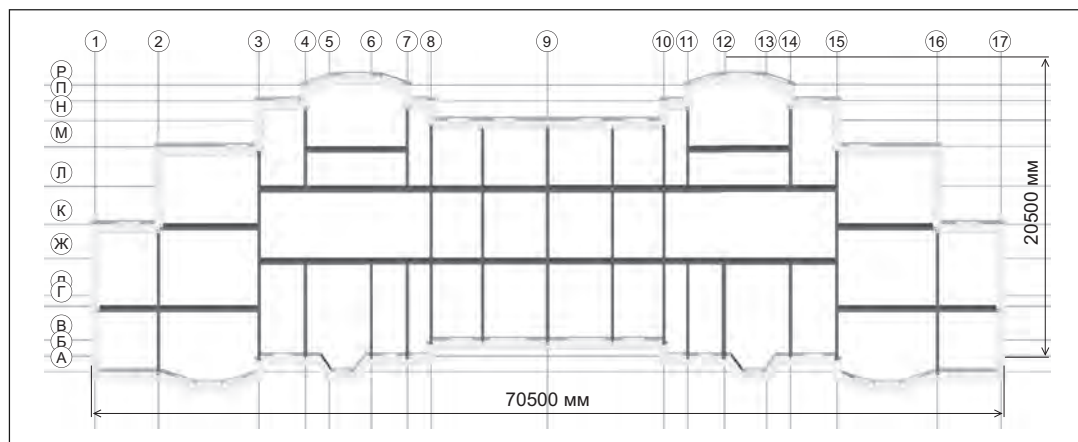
Схема типового этажа (внутренние несущие железобетонные монолитные стены толщиной 160...200 мм, несущие внешние кирпичные стены толщиной 510...640 мм)
